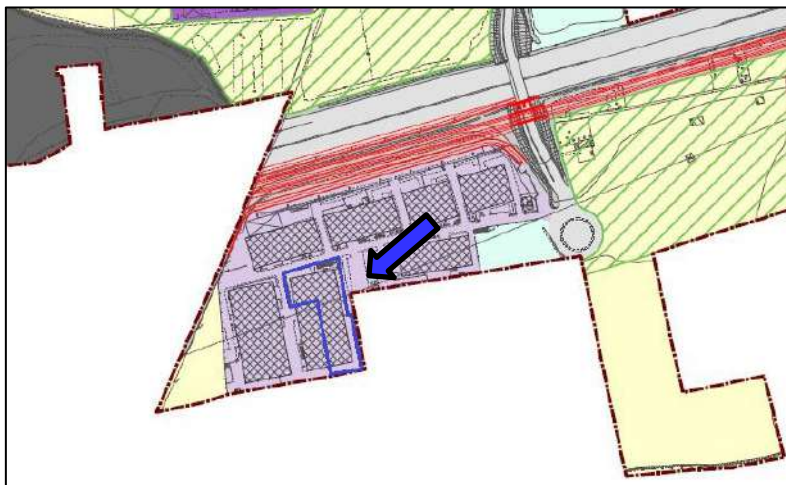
localizzazione dell'impresa rappresentazione dell'impianto INGECO
